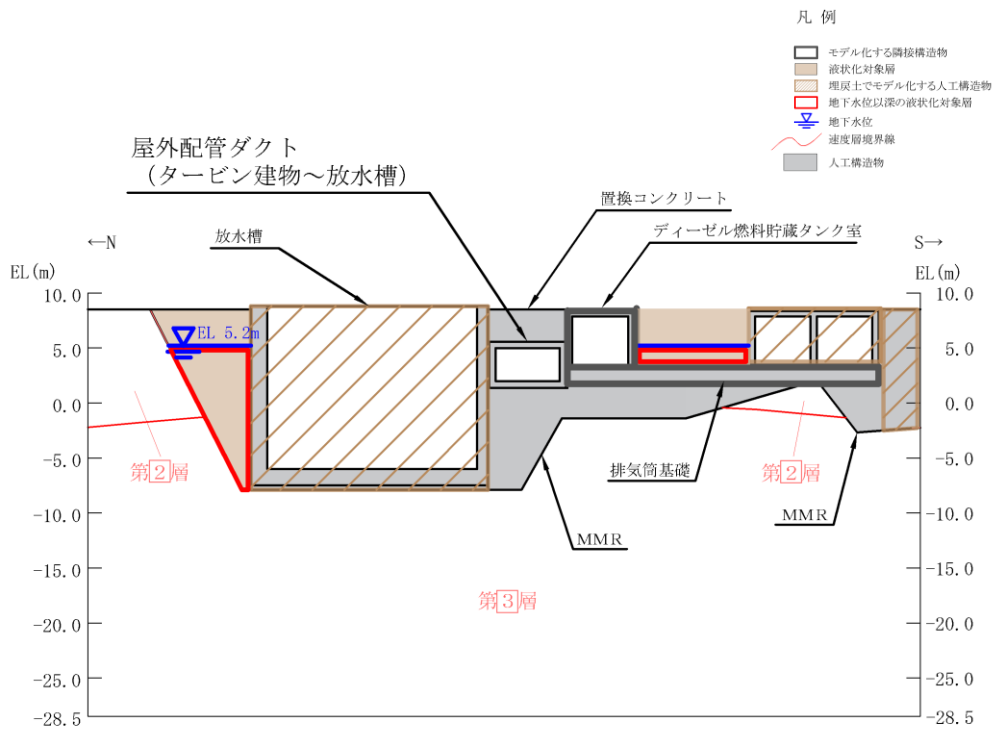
屋外配管ダクト (タービン建物～放水槽) 評価対象断面図 (A-A 断面)
